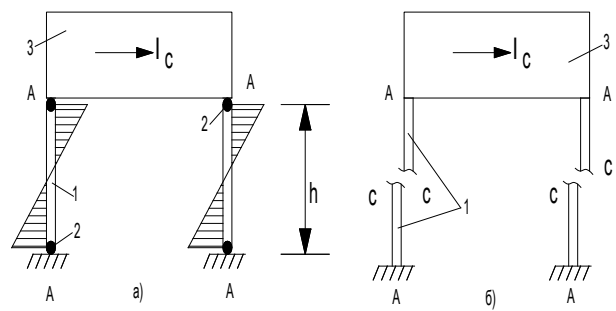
Расчетная схема здания с гибким каркасным первым этажом, а и б – соответственно ожидаемая и фактическая схемы разрушения; 1 - колонны; 2 - пластические шарниры в опорных сечениях колонн; 3 - жесткий диск верхних этажей.
